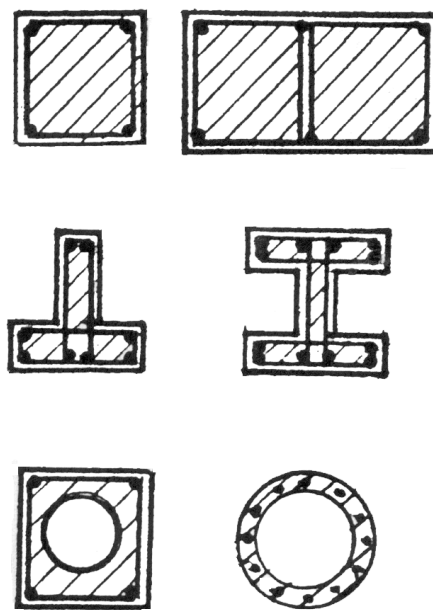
Формы поперечных сечений железобетонных свай: квадратное, прямоугольное, тавровое, двутавровое, квадратное с полостью, круглое
